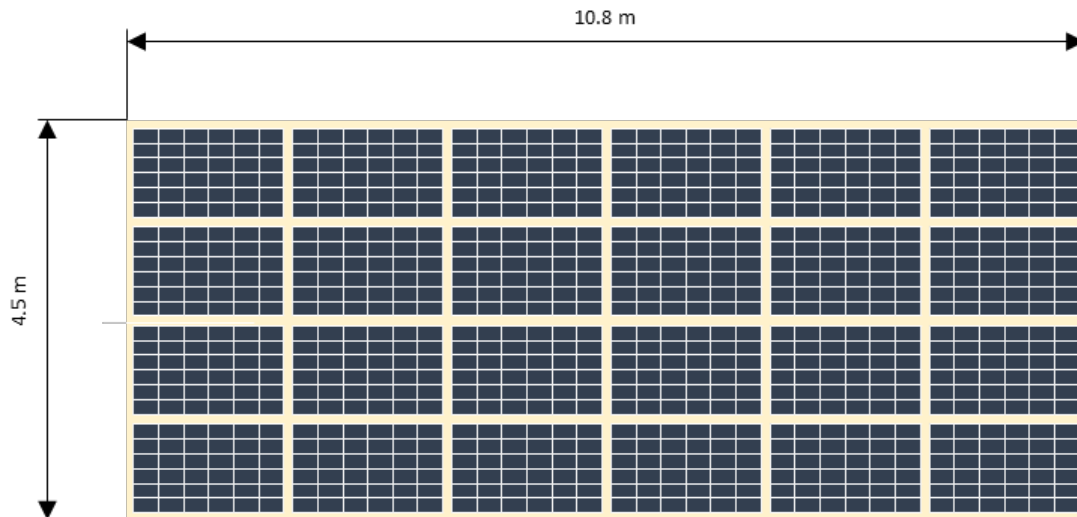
Configuración horizontal de los paneles. Fuente: elaboración propia.
